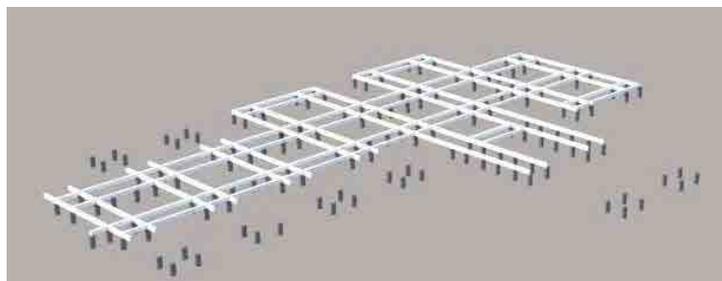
Detalle de cimentación y entramado de vigas del edificio socio administrativo. Fuente: autores, 2018.
